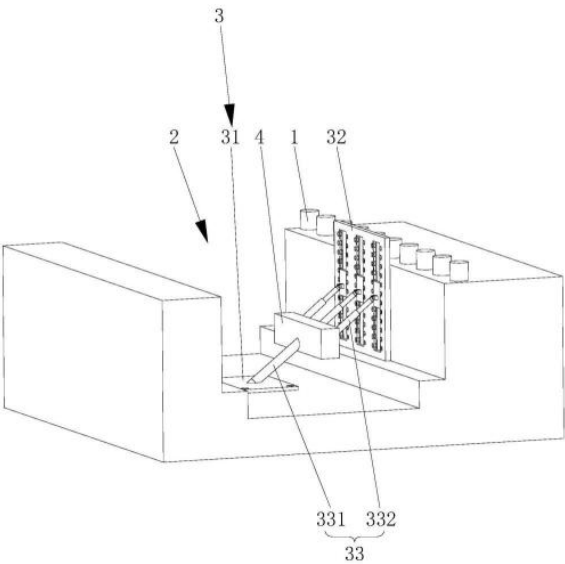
既有管线下方土方开挖施工方法的施工过程中即时支护装置的状态示意图
